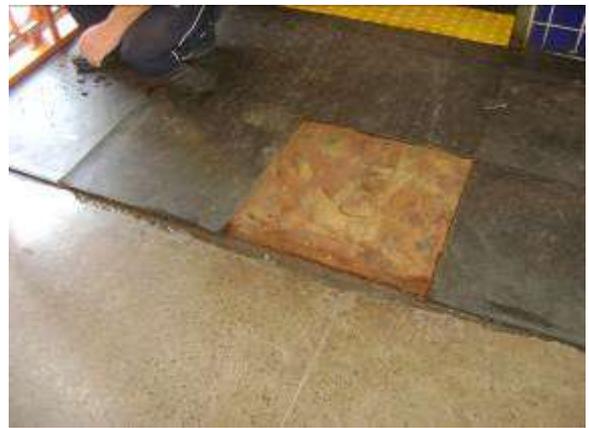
Piso podotátil, colado sobre chapas metálicas corroídas pela ferrugem.
